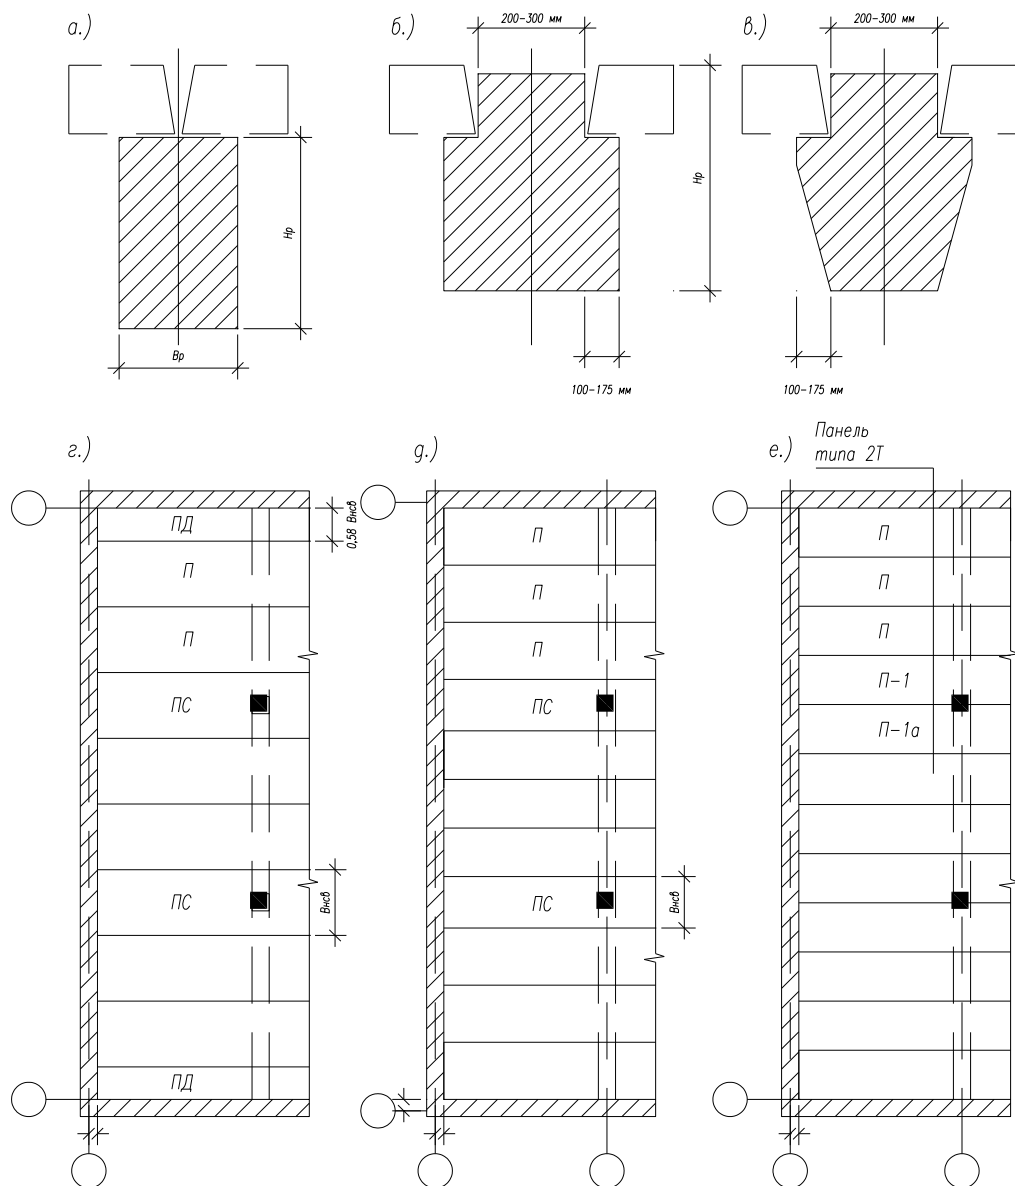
К компоновке сборного ж.б. перекрытия
